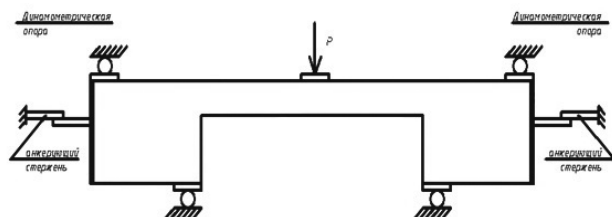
Схема испытания фрагмента неразрезного перекрытия
